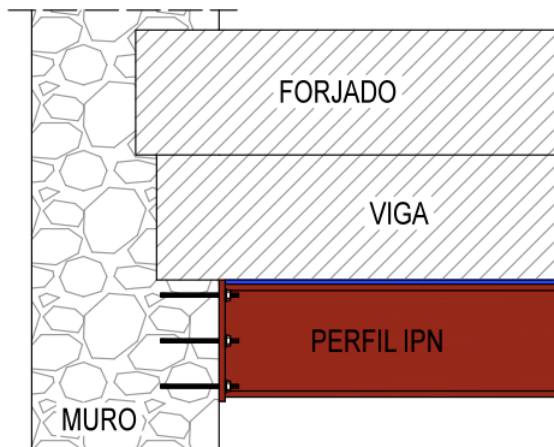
Refuerzo de viga mediante perfil IPN. Fuente propia.
